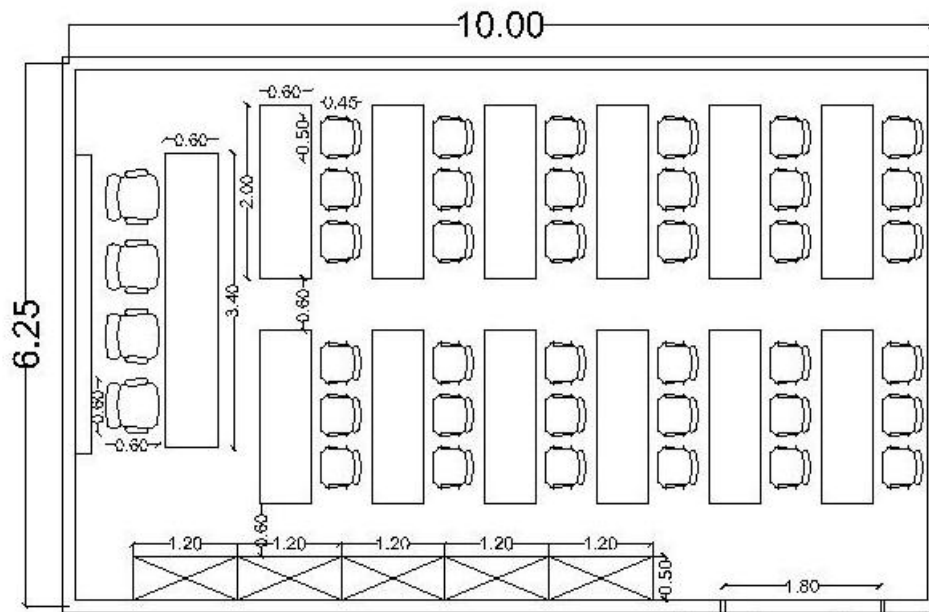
Studi Ruang Ruang Rapat Pengelola (20 orang)
